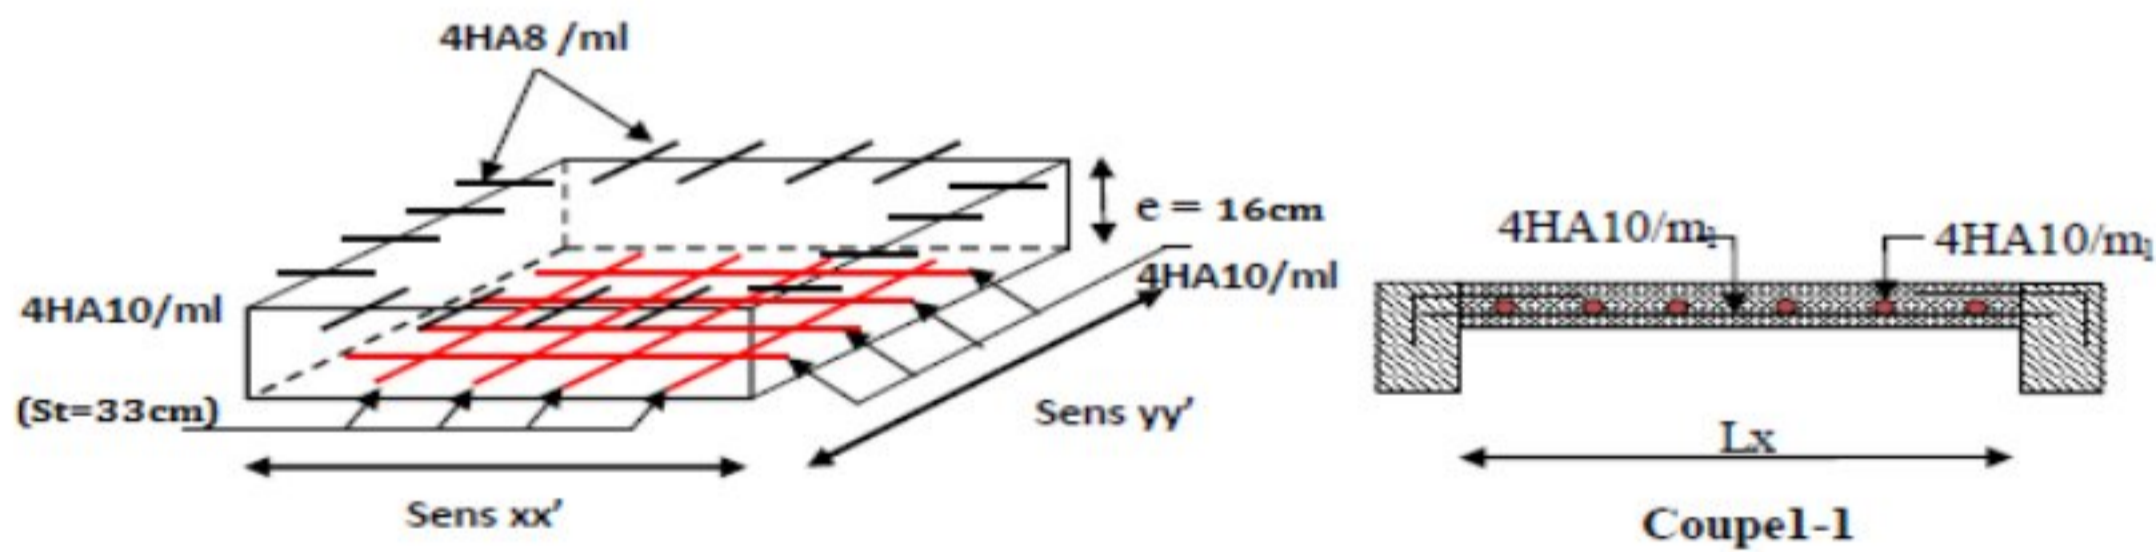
schéma de ferrailage de la dalle sur 4 appuis
